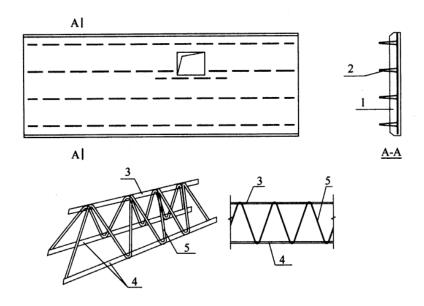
叠合板的预制板设置桁架钢筋构造示意 1一预制板; 2一桁架钢筋; 3一上弦钢筋; 4一下弦钢筋; 5一格构钢筋
